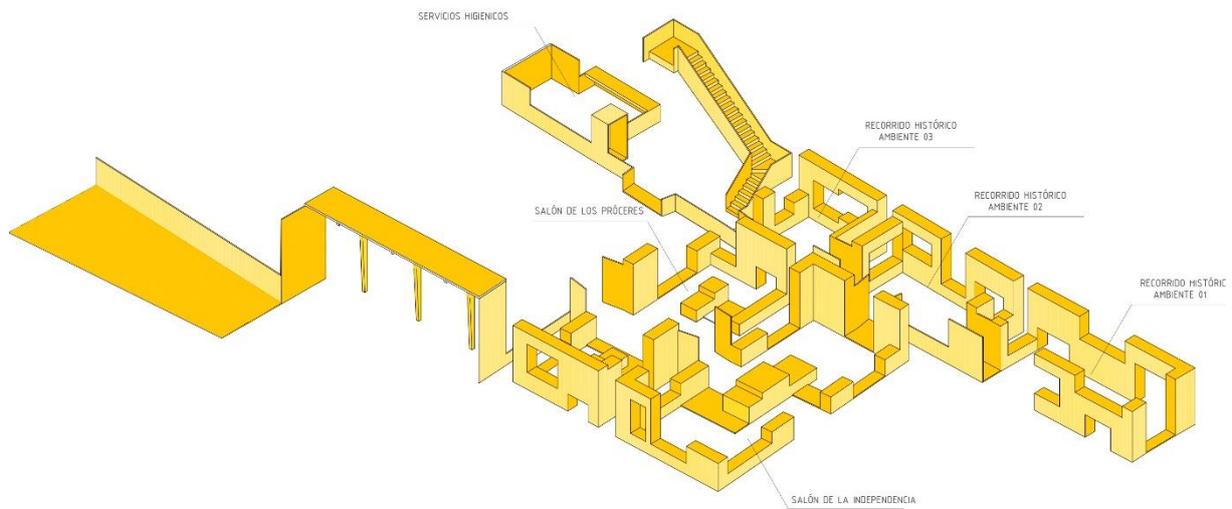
Planta del proyecto de restauración de la Casona Montjoy. Elaboración Propia
